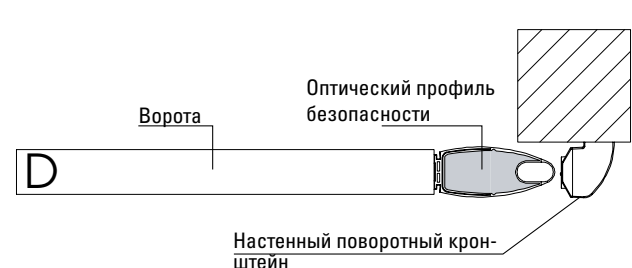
Рис. D - Монтаж с поворотным кронштейном для крепления к стене
